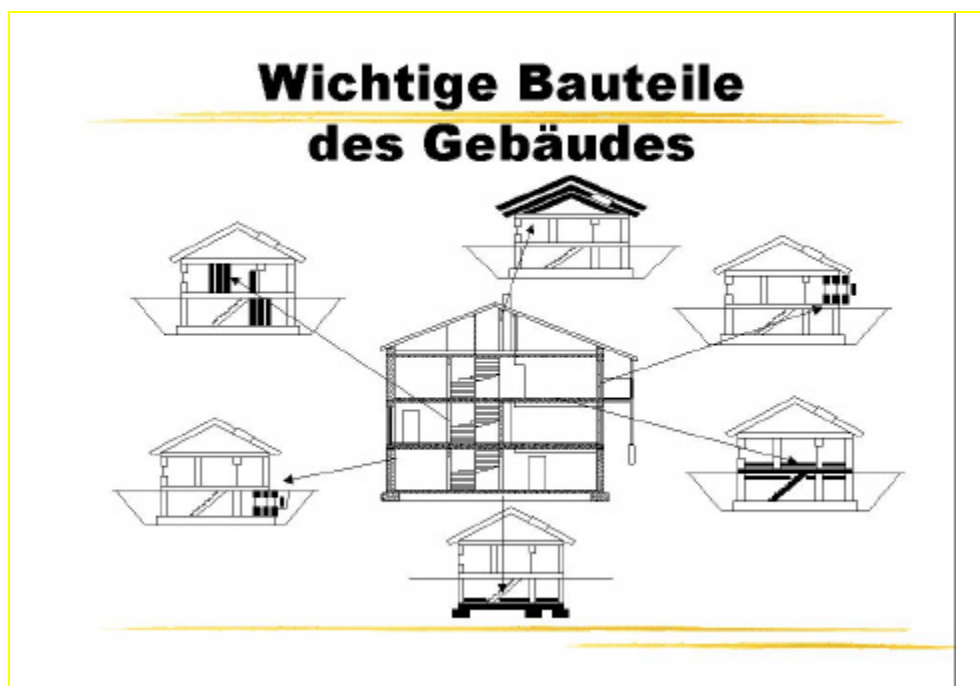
Konstruktionen des Gebäudes mit Makroelementen
